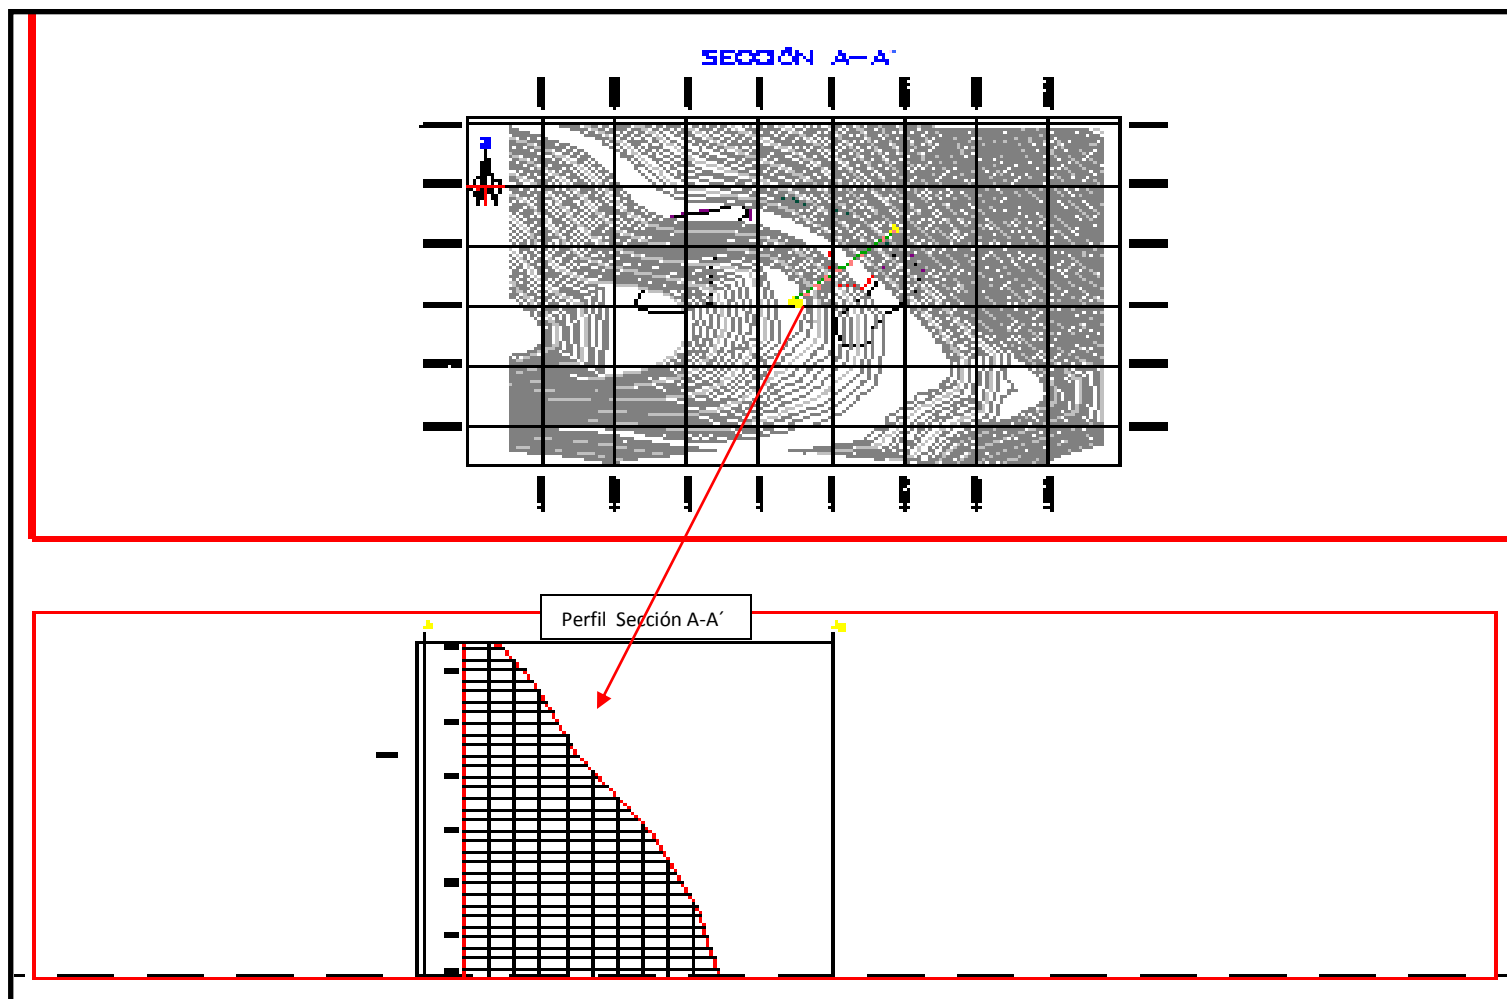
Sección 01, corte A-A', vista en planta (parte de arriba) y vista longitudinal (parte de abajo).
